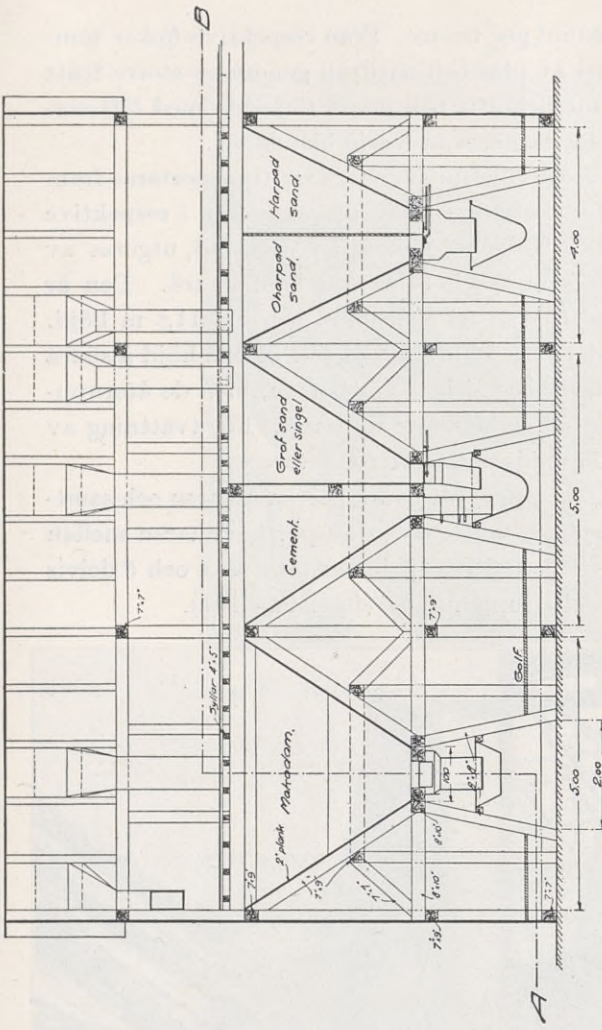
Plan av anordningar för betonggjutning i slusstrappan vid Trollhätten.
